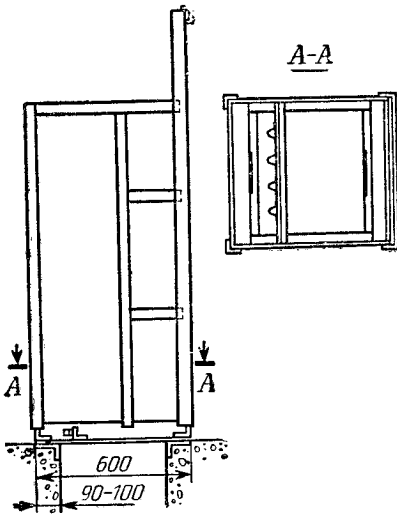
Установка панели ПНН-02 на фундаменте над кабельным каналом.
